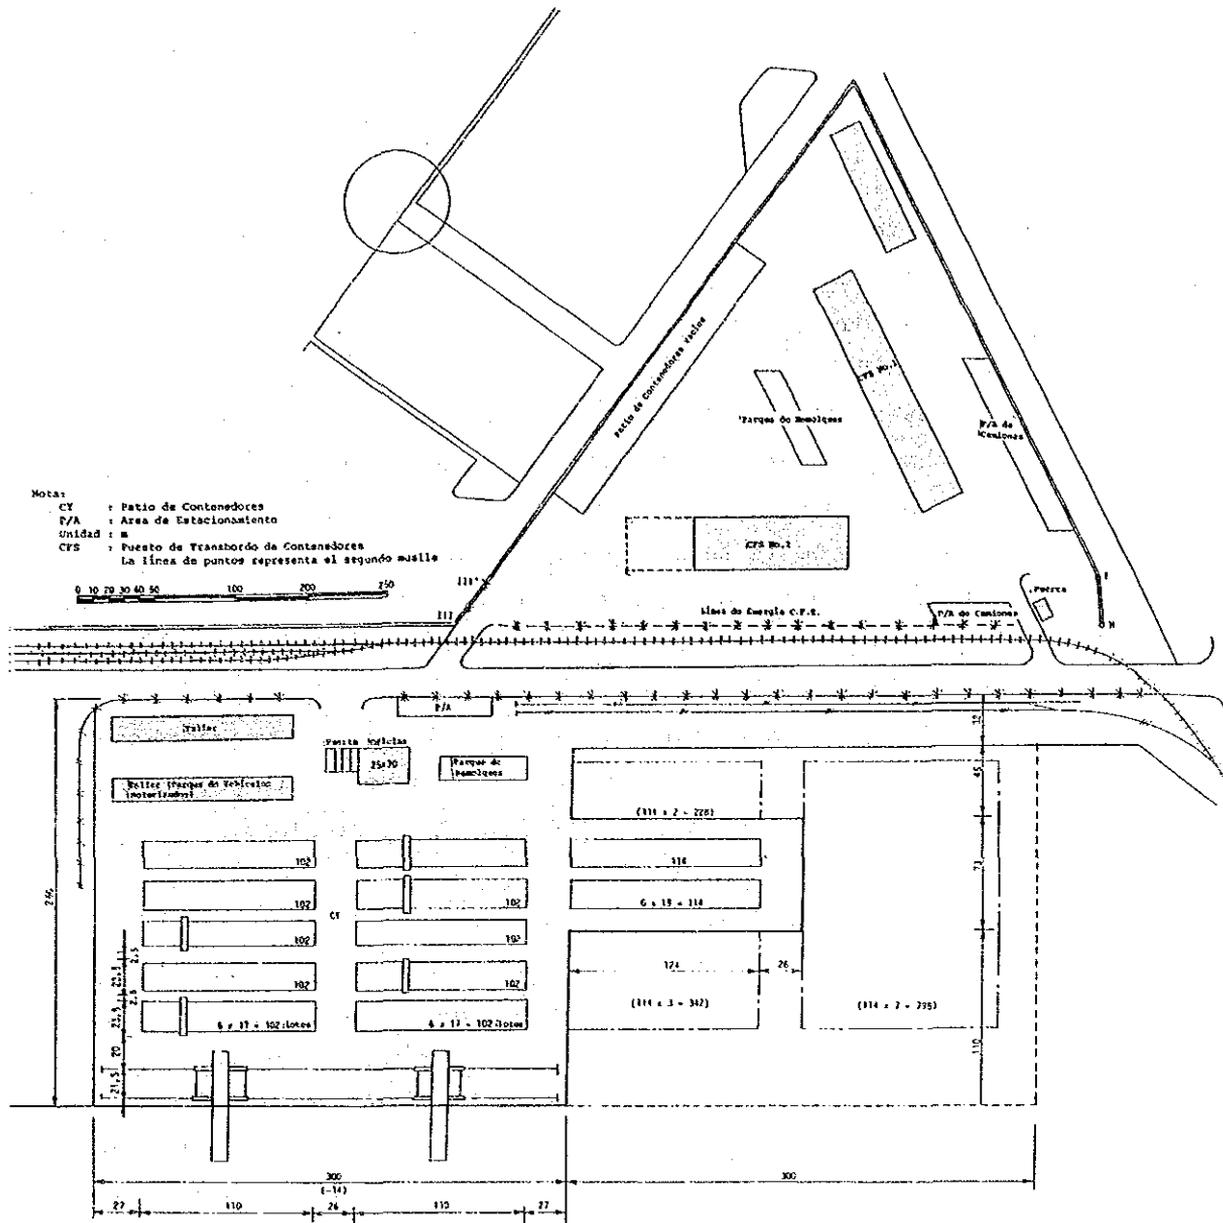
Plan de Disposición de la Nueva Terminal de Contenedores
